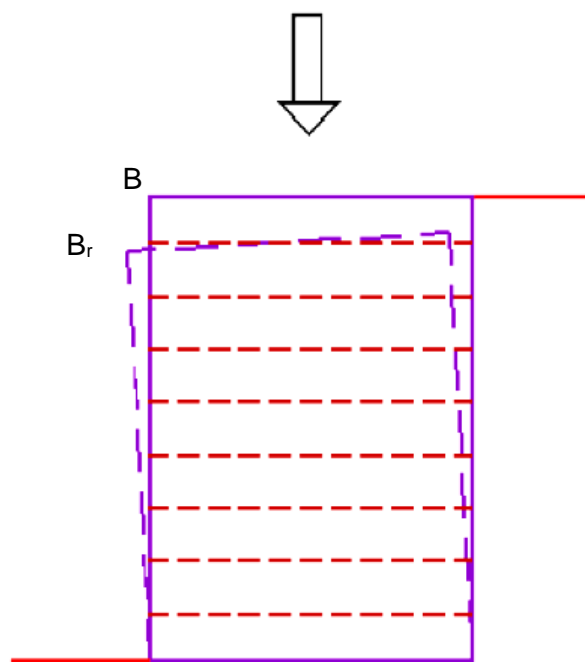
Presión del bloque reforzado aplicado sobre la fundación.
